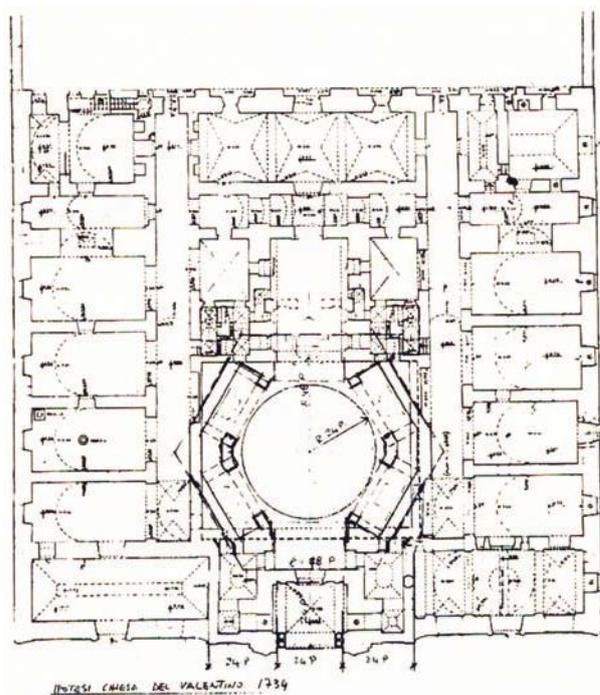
«Ipotesi planimetrica della chiesa desunta dal rilievo della fondazione» (rilievo e didascalia tratti da LAMACCHIA 2002, p. 139)
